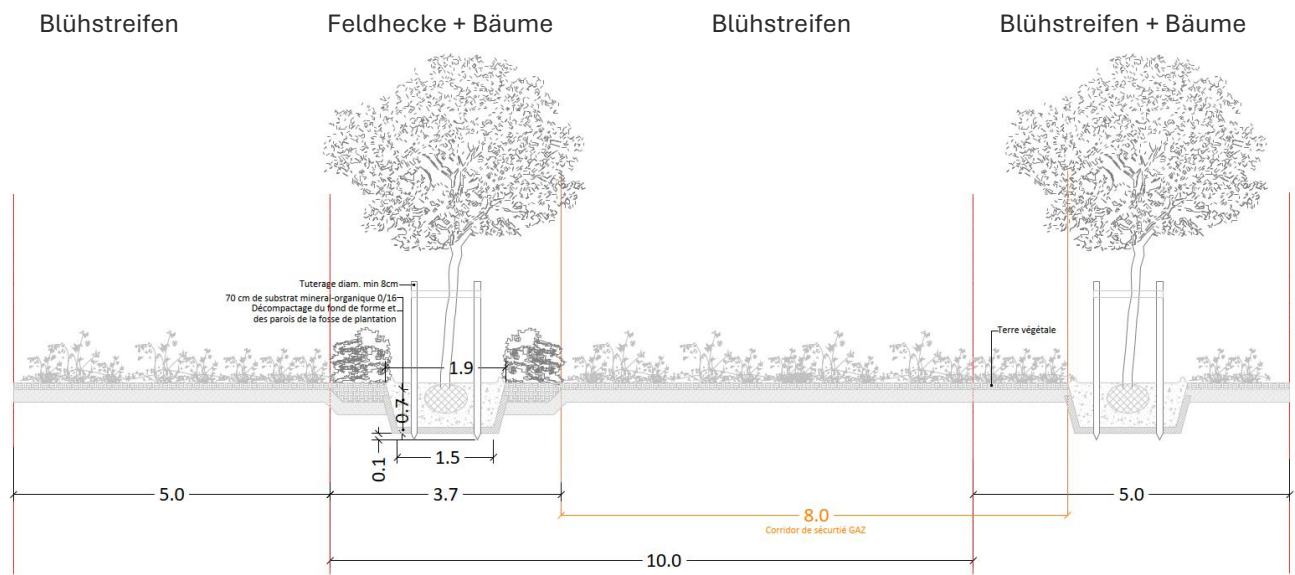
Detail A-A des Plan de Plantation, nördlicher Grünkorridor zwischen Ilot 8 und Ilot 10 (Quelle: Papaya Sàrl 2025). Größere Darstellung in Anhang 06a.
